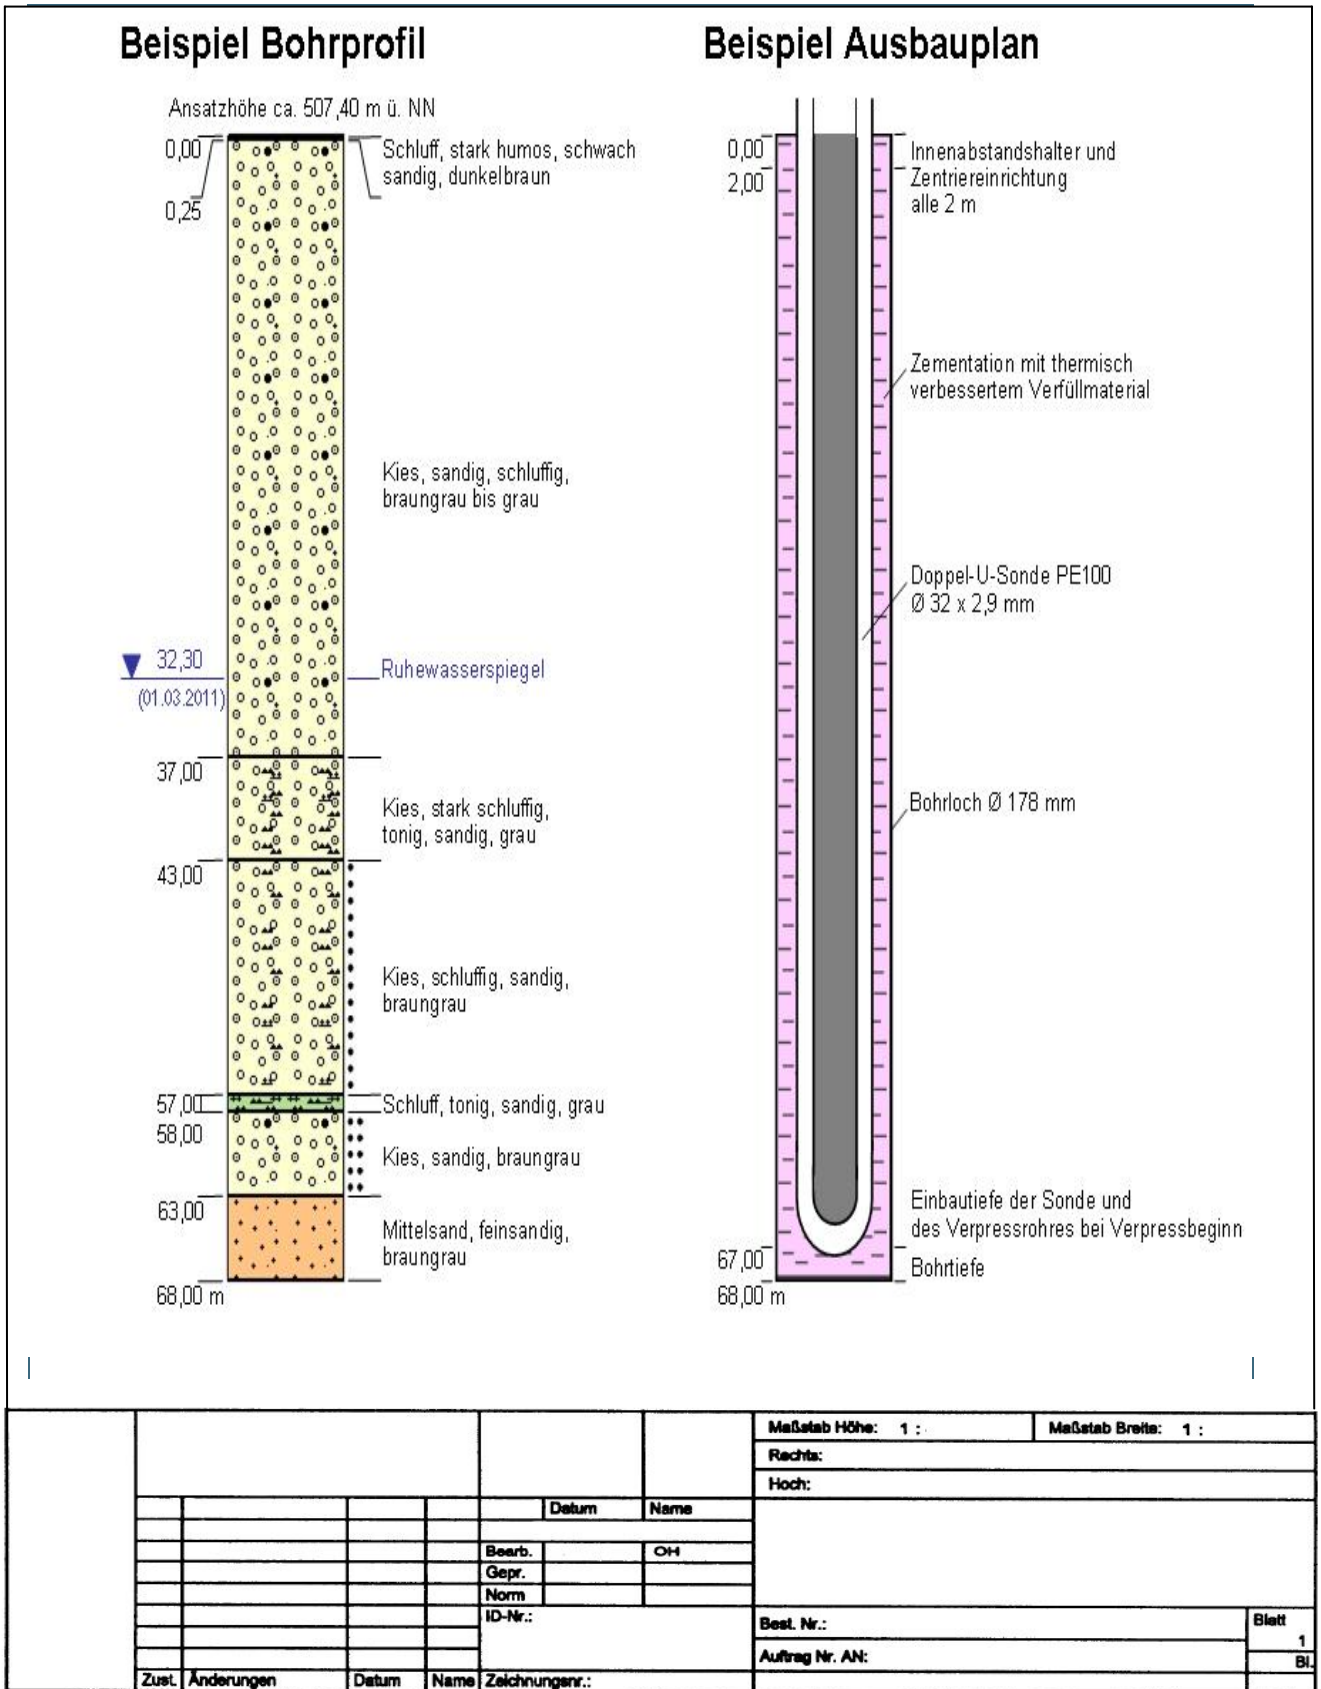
Beispiel Bohrprofil / Ausbauplan Erdwärmesonde (Quelle: LfU)
